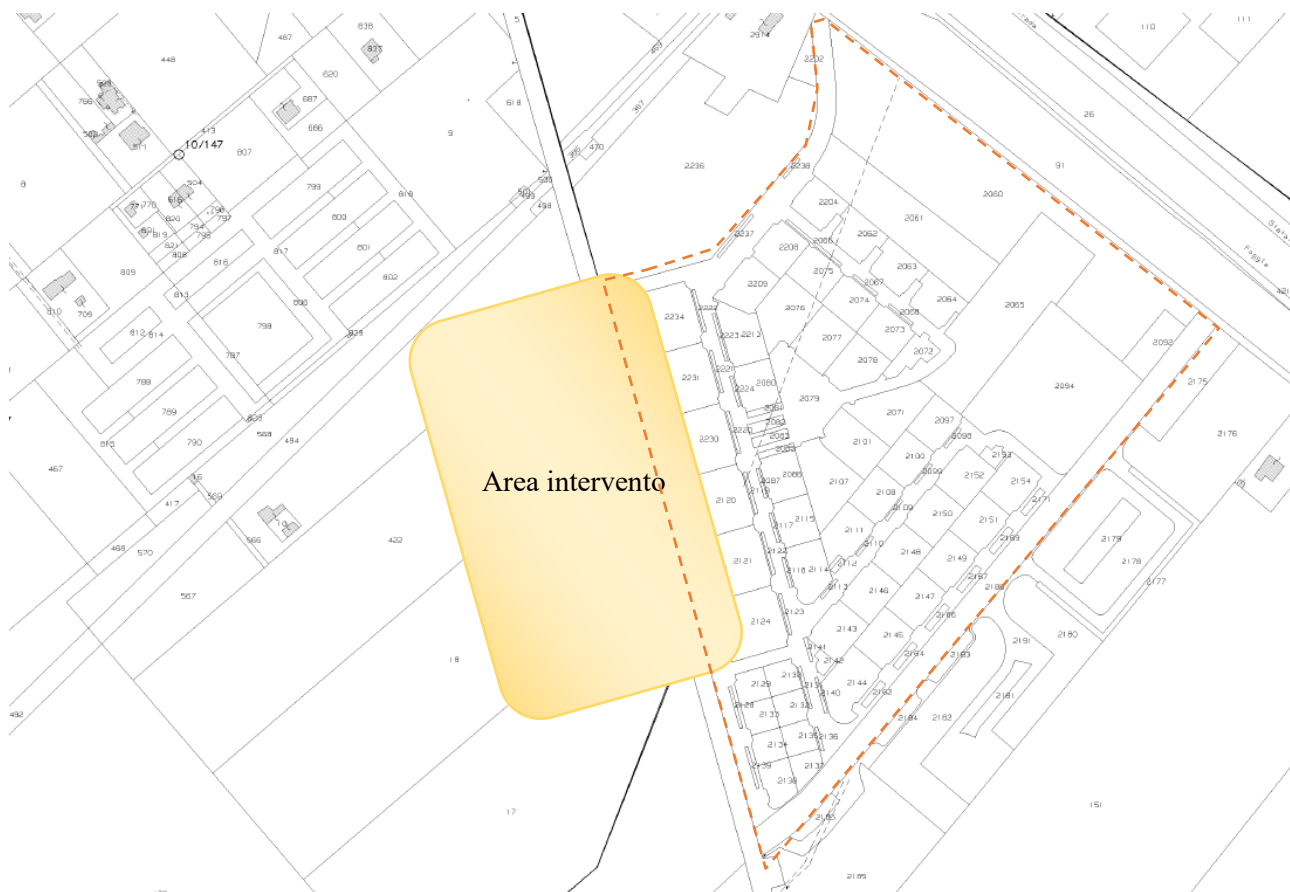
Stralcio della Planimetria di Cantierizzazione con la viabilità di accesso alla Fermata
